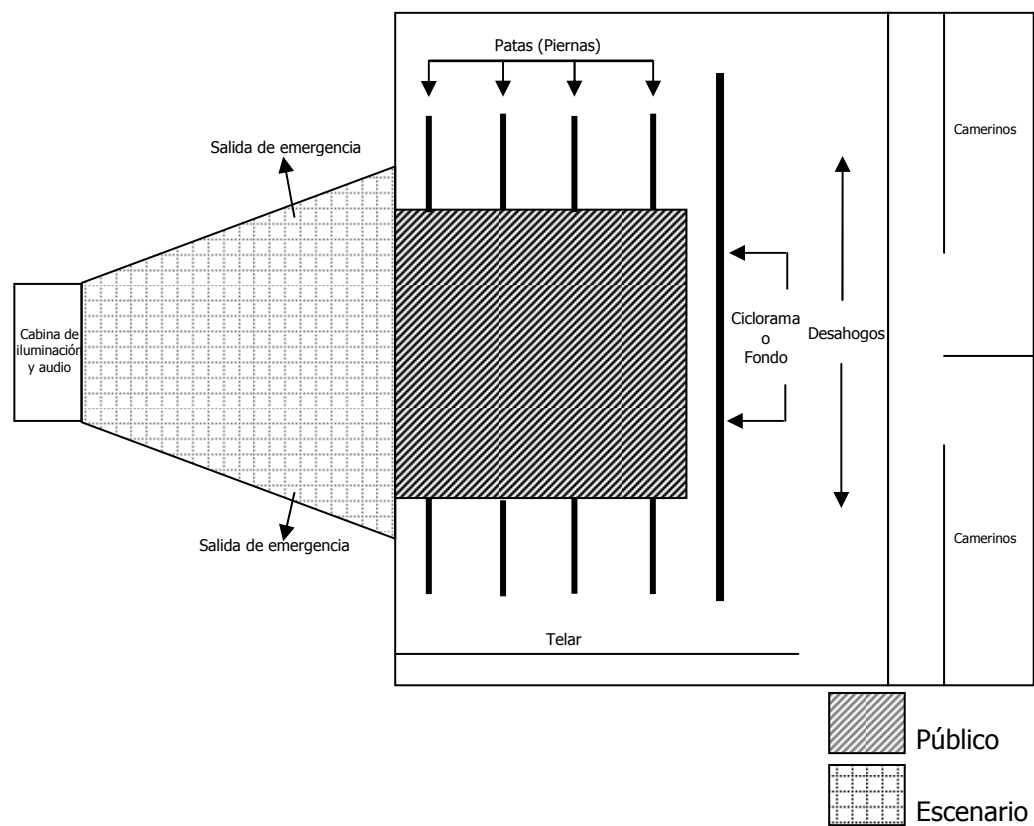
Vista en planta. Estructura general de un teatro a la italiana. Sin escala.
